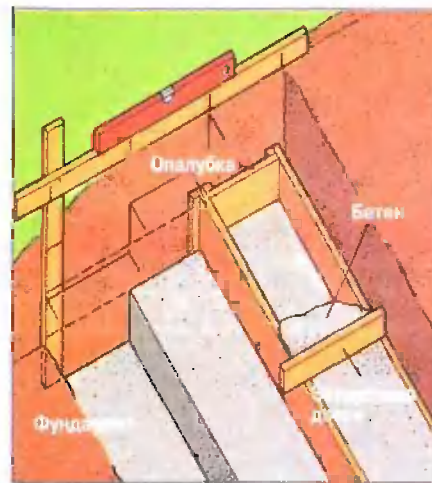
Ориентируясь по меткам на крестовине, сооружают опалубку для отливки бетонных ступеней, смещенных по отношению к планируемой лестнице
